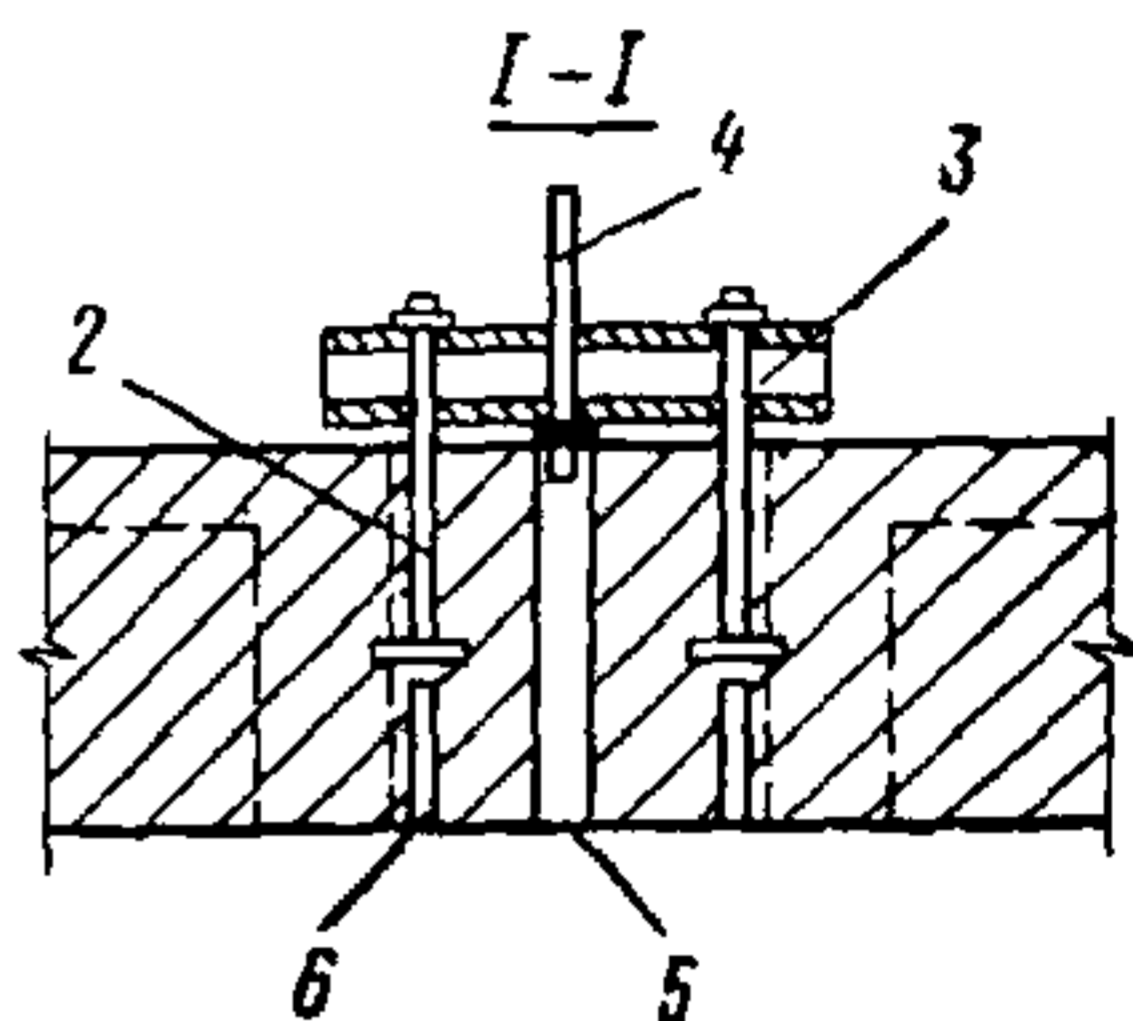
Приспособления для подъема и закрепления ребристых перекрытий
